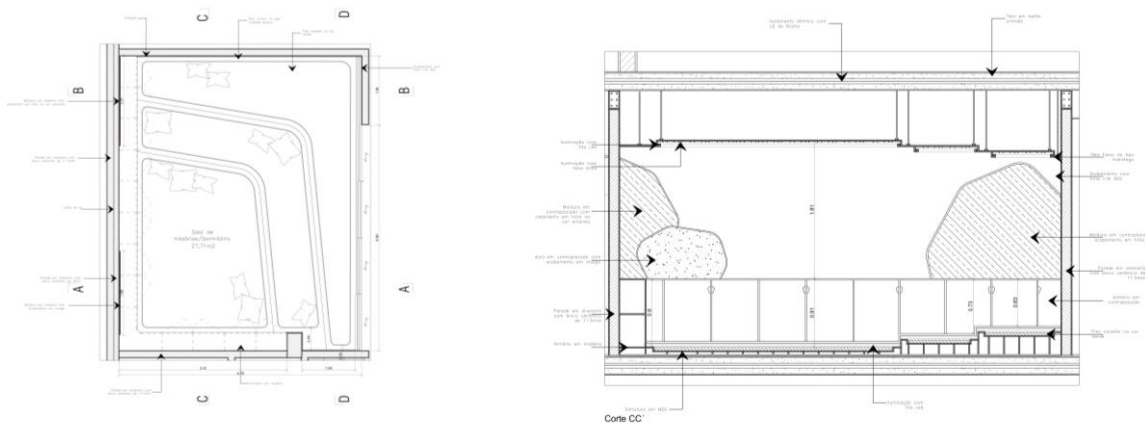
Planta e corte do pormenor da sala de histórias/dormitório. Fonte: Augusta Ngonga, 2024.
